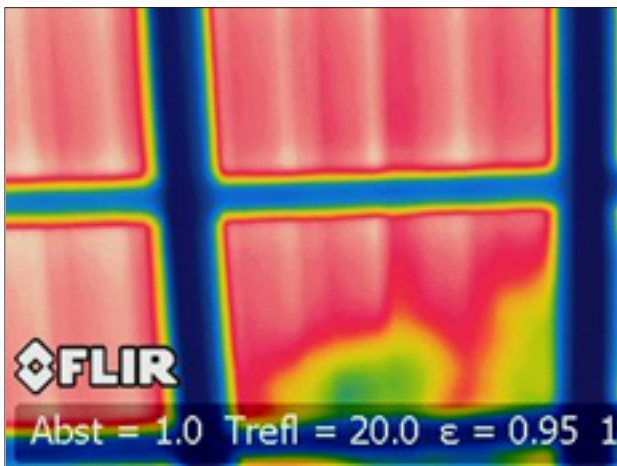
Ungedämmte Dachhaut im Auslauf
